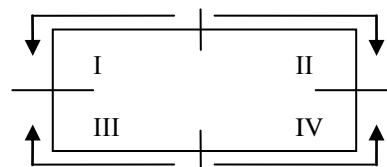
Схема разбивки здания на захватки при укладке фундаментных балок и стеновых панелей
